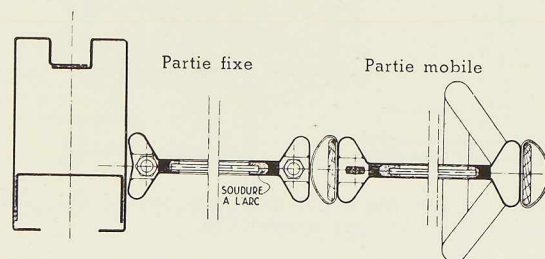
Demi-coupe horizontale dans la porte vitrée séparant le hall d'entrée du restaurant (voir fig. 12).
